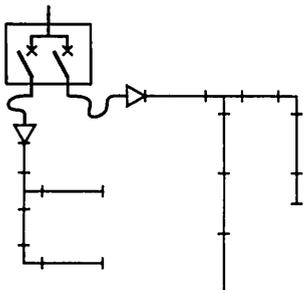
Schéma d'installation en canalisations préfabriquées.
